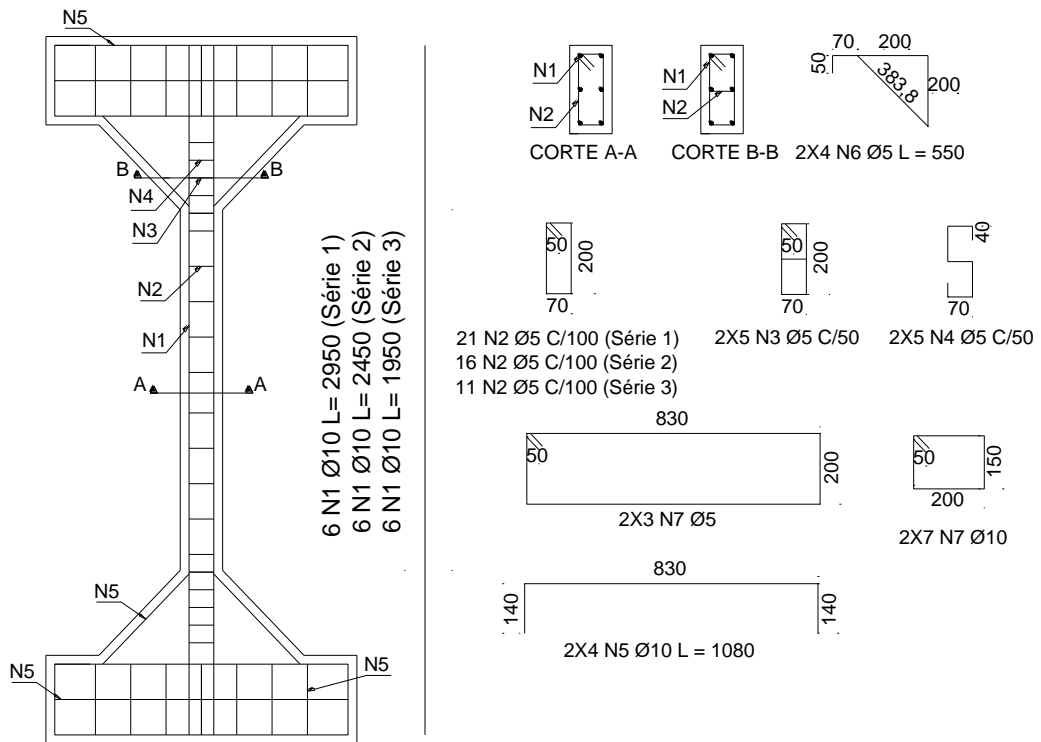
Detalhamento da armadura dos pilares (MELO, 2009)
